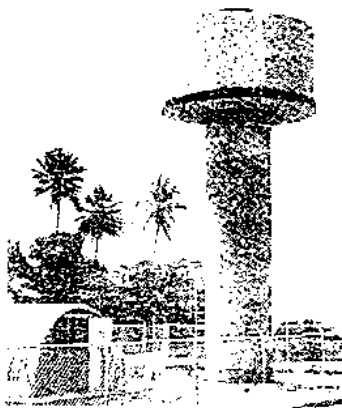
Estanque elevado de concreto armado. Boscán, Estado Zulia. Venezuela.
